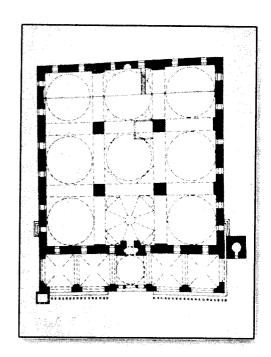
مسجد الباب المردوم بطليطلة (مسقط أفقي وقطاع) عن: مورينو
